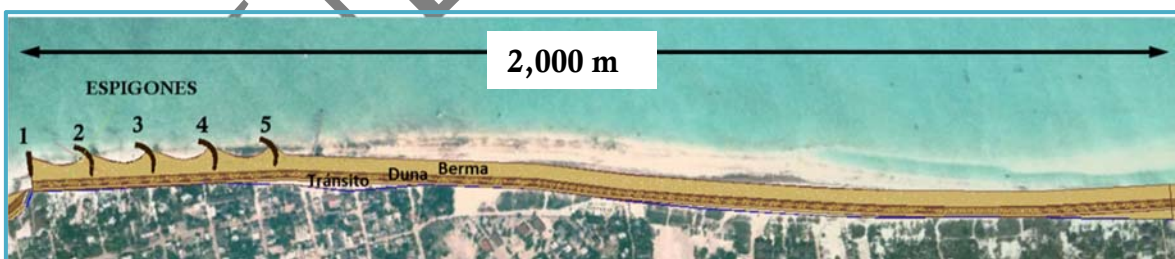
Plano de las obras a implementarse en la Zona Centro.
